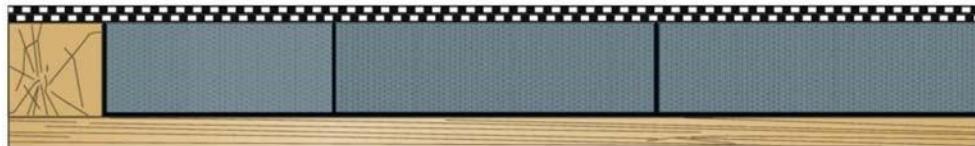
Coupe de principe sur rive avec butée en bois, sur élément porteur bois - panneaux à base de bois
